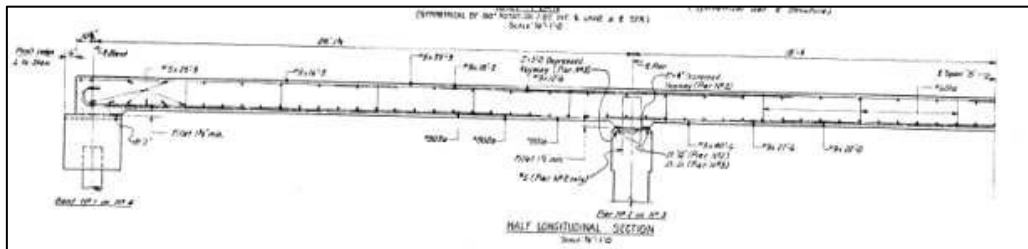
Detalle refuerzo longitudinal superestructura puente No 2
